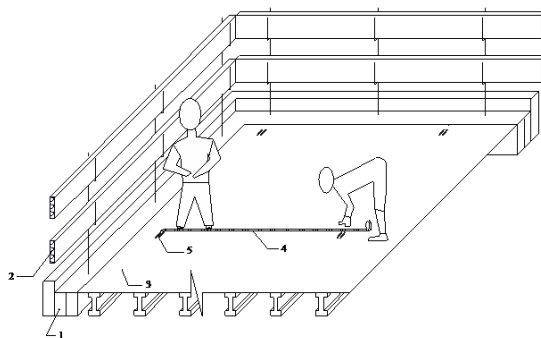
Розбивка палуби при влаштуванні нижньої арматурної сітки: 1 - несуча стіна; 2 - інвентарна огорожа; 3 - палуба опалубки перекриття; 4 - рулетка; 5 - винесені на палубу геодезичні осі
